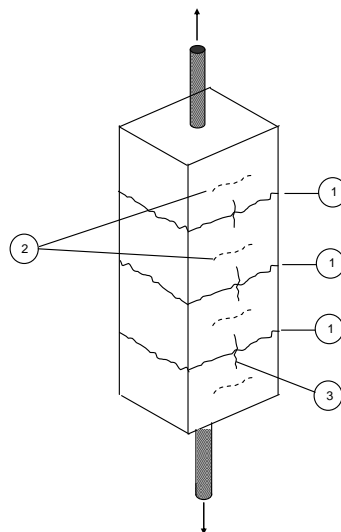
Configuración de fisuración de un espécimen sujeto a tensión (según Broms)
